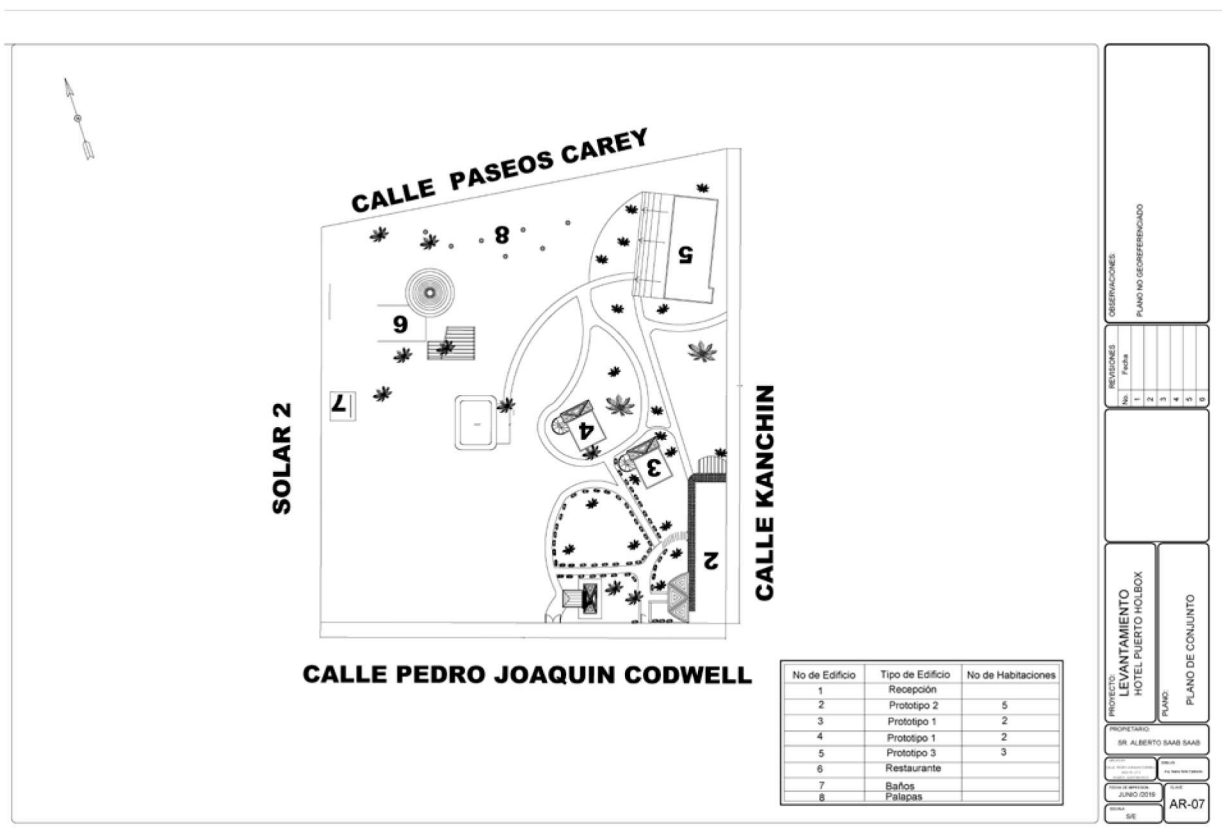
Plano Planta Conjunto de Hotel Puerto Holbox
